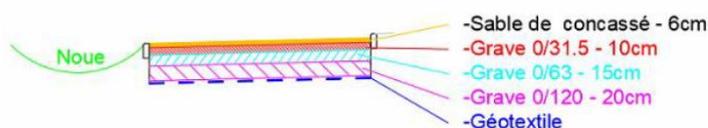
Coupe type sur la voirie (Plan AVP, 03.2022)
